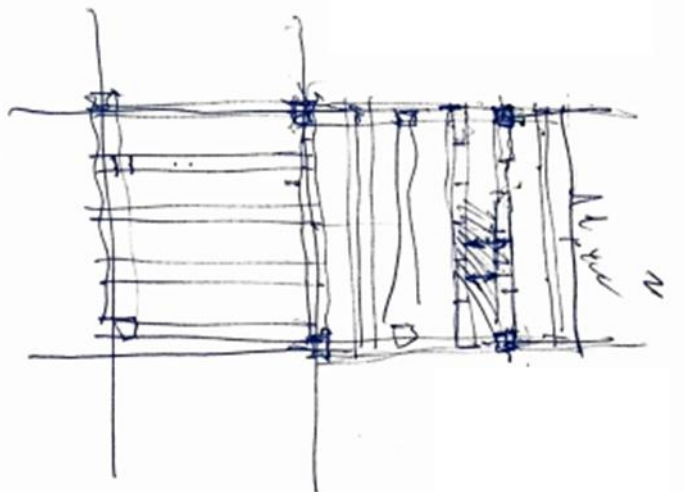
Croqui da disposição dos pilares e prateleiras.
